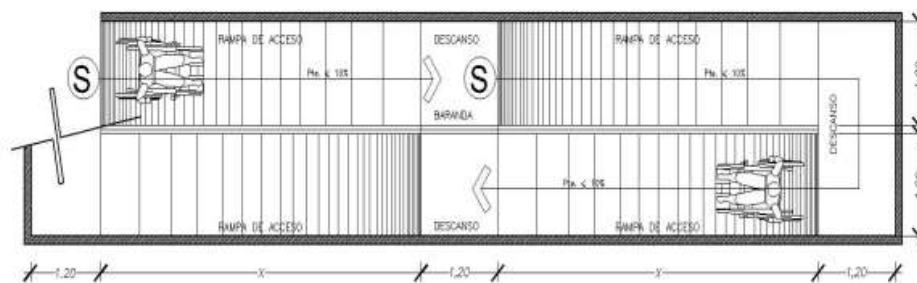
Vista en planta estructura Rampa, Fuente: [www.google.com](http://www.google.com)
